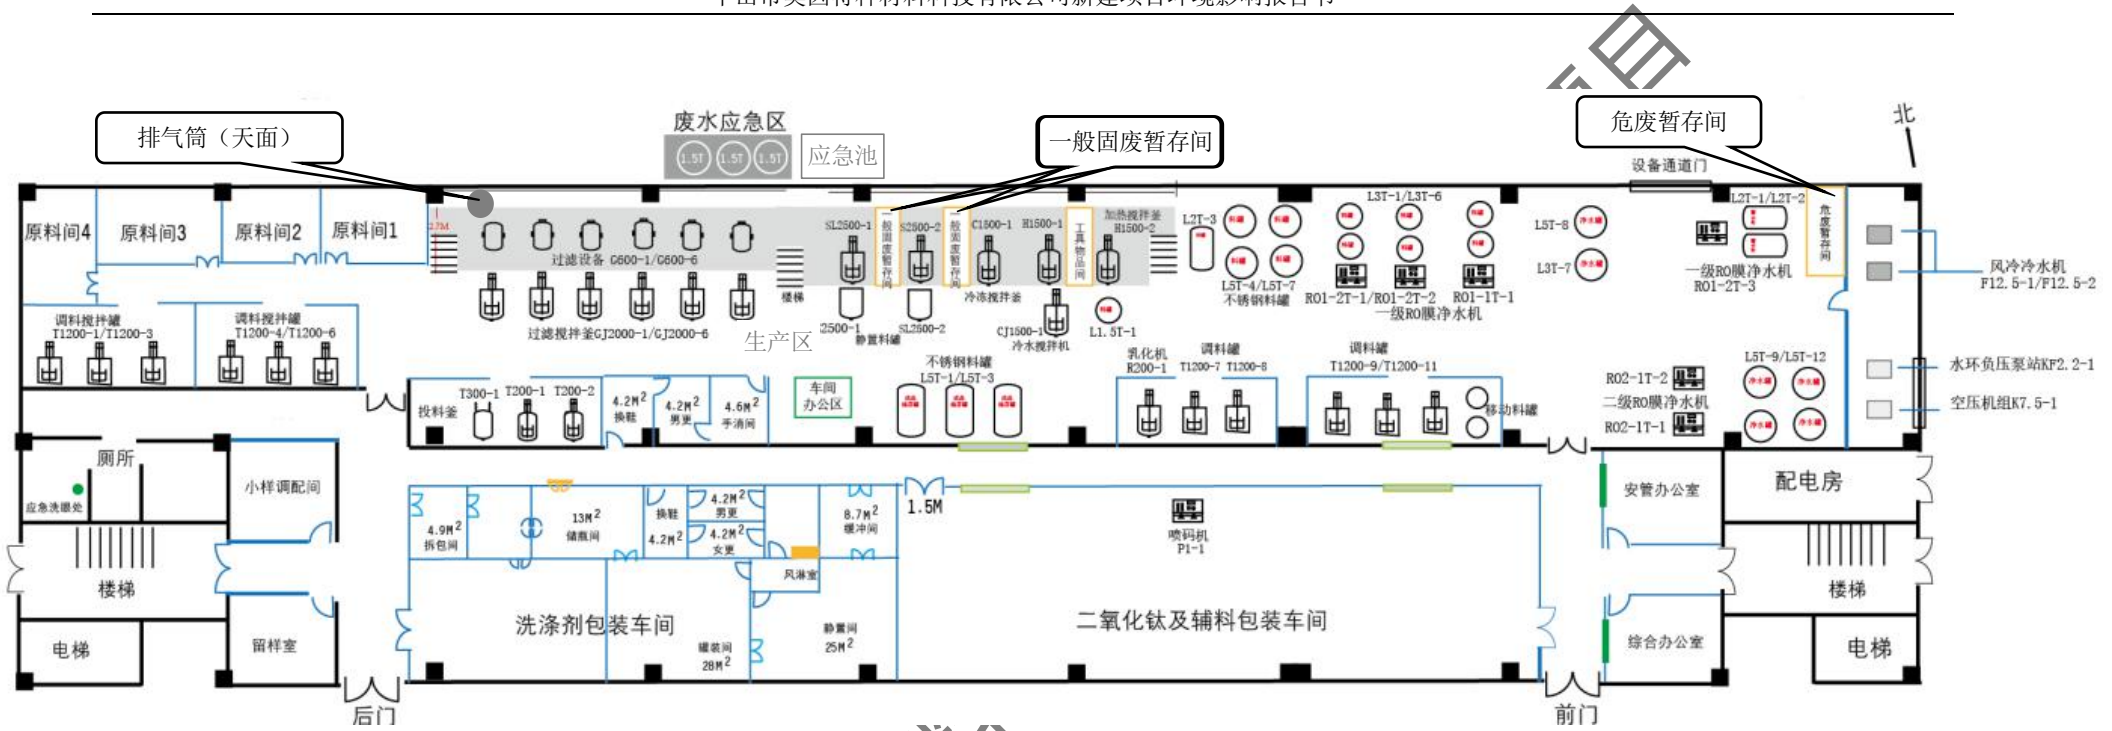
项目 1# 厂房 (4 栋 1 楼) 平面布置图
